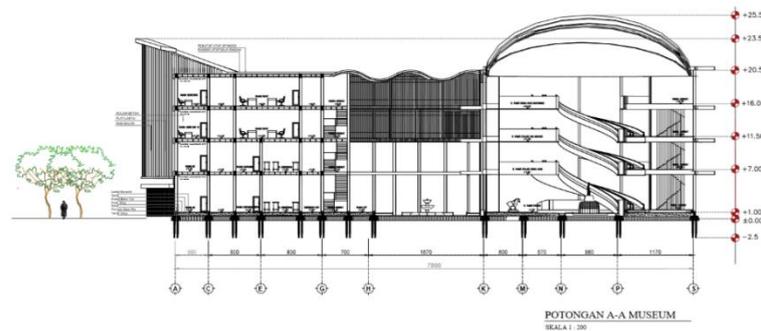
Aplikasi Bentuk dan Tampilan
